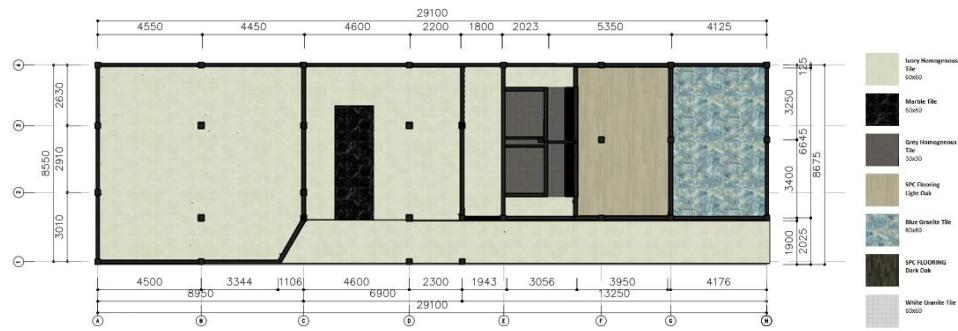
Alternatif 2 Layout Lantai 3(Terpilih)
